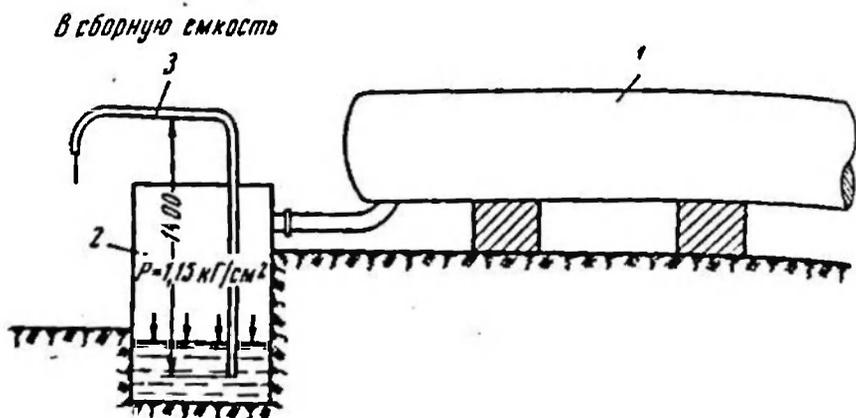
Устройство для сбора и откачки газового конденсата. 1 — приемный газовый коллектор 1 ступени; 2 — емкость для сбора конденсата; 3 — продувочная линия.
